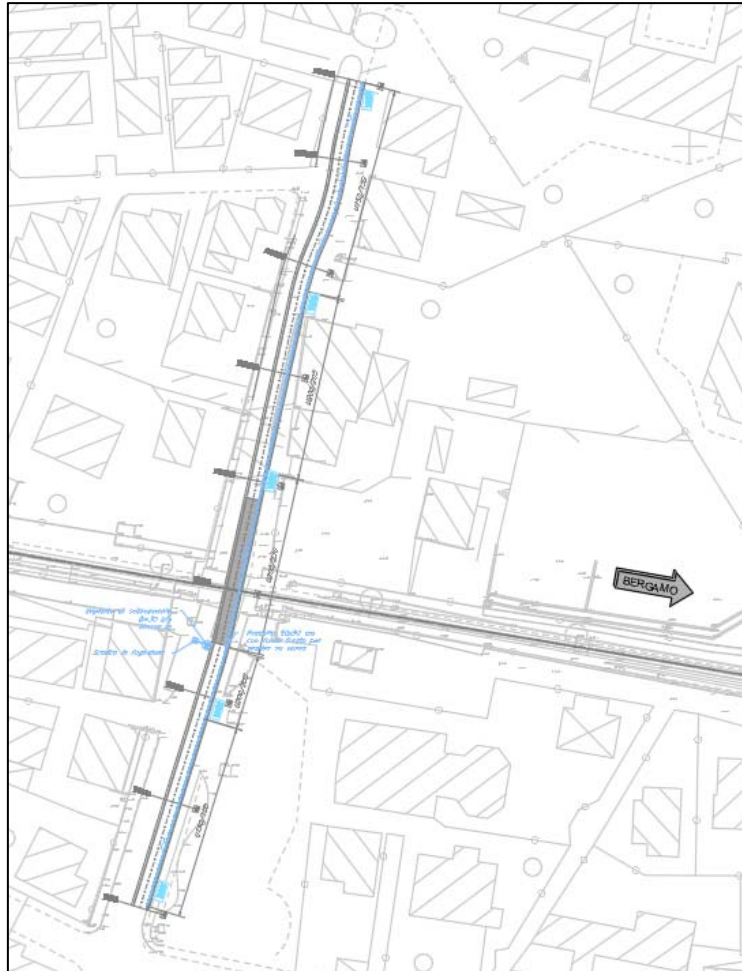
Stralcio planimetrico sistema di drenaggio.
